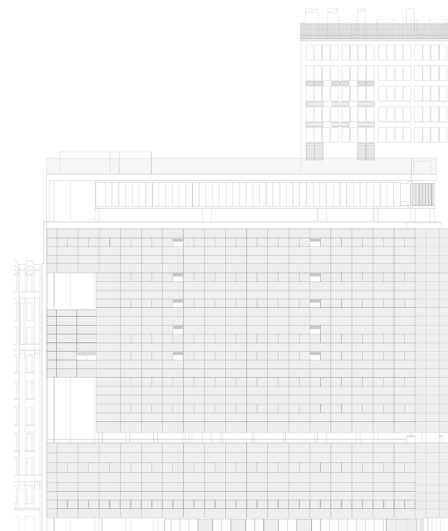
Fachada Calle 24 de Maio. (Fuente: MMBB Arquitectos).
